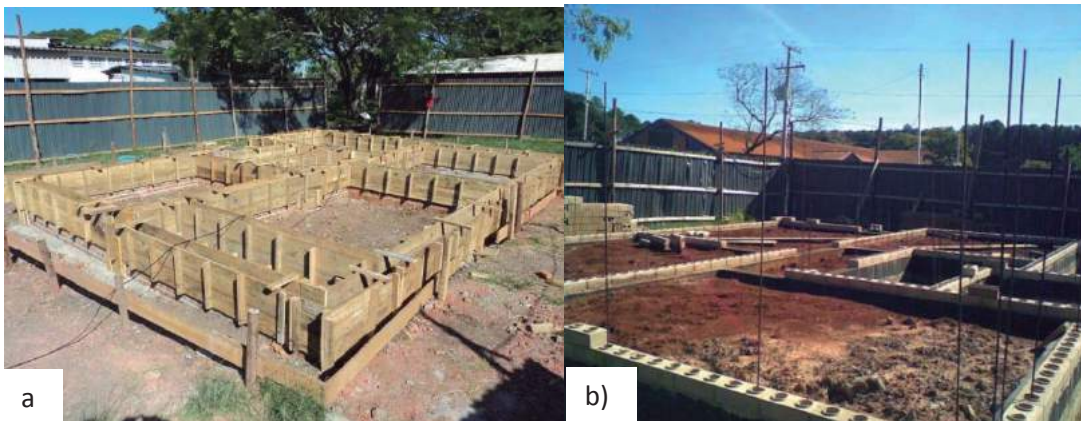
a) Vigas de fundação; b) Primeira fiada de alvenaria de solo cimento.
